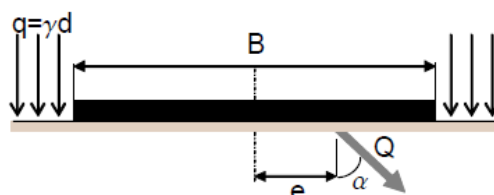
Schema di una fondazione superficiale soggetta a carico eccentrico e inclinato (Marchi, 2008).
